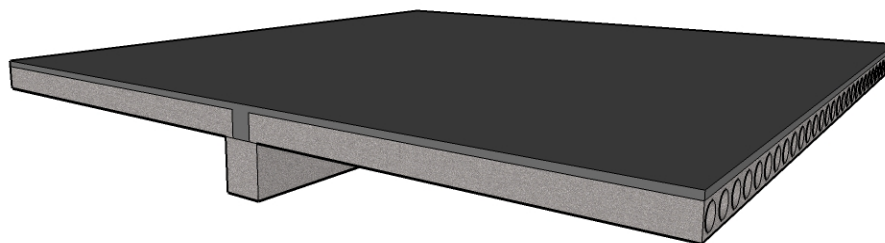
Vista tridimensional do modelo *viga em concreto protendido composta*.
